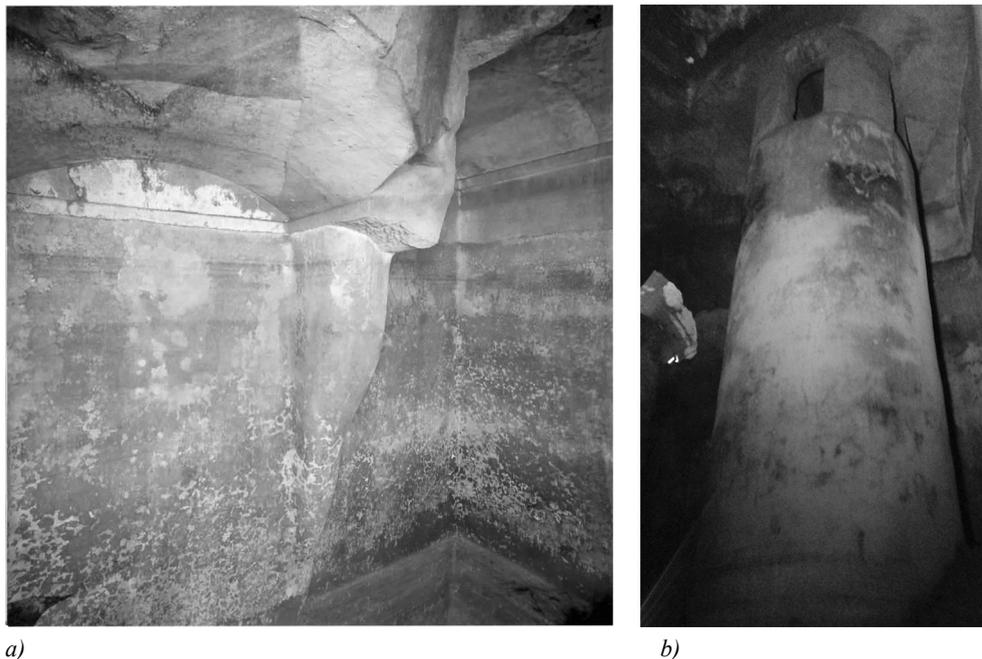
Palazzo de' Mari, cisterna con pilastro pozzo: a) pilastro pozzo; b) camere funerarie ellenistiche riutilizzate.
